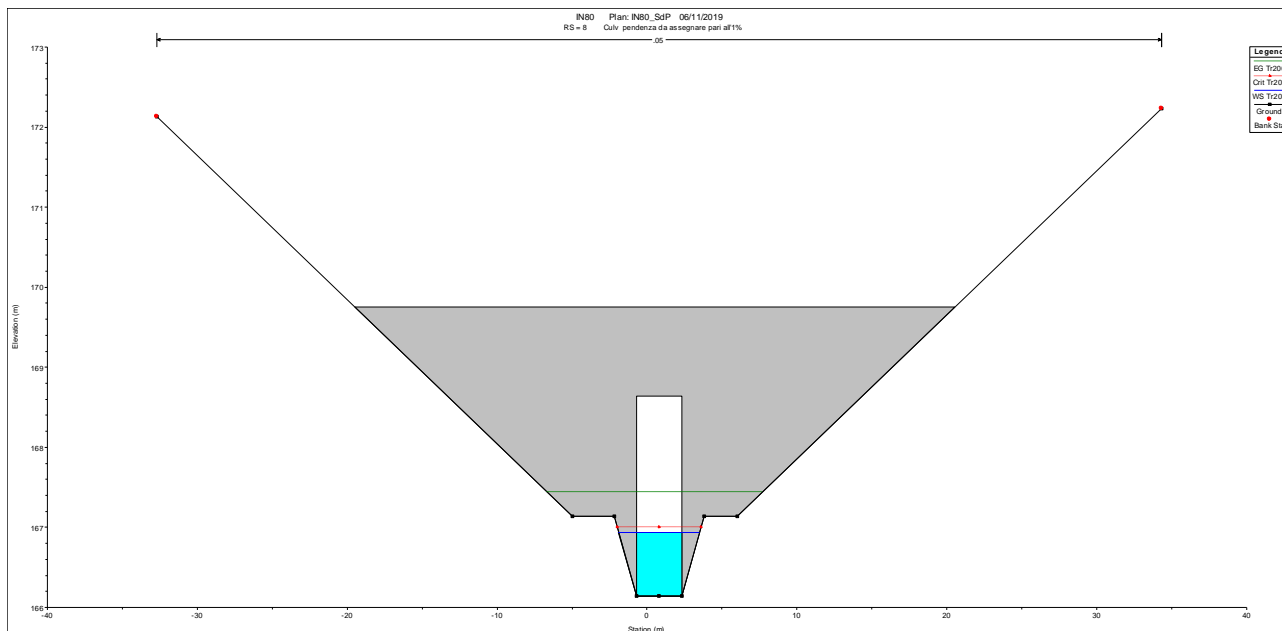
Sezione valle manufatto 1 – stato di progetto interferenza IN80.
